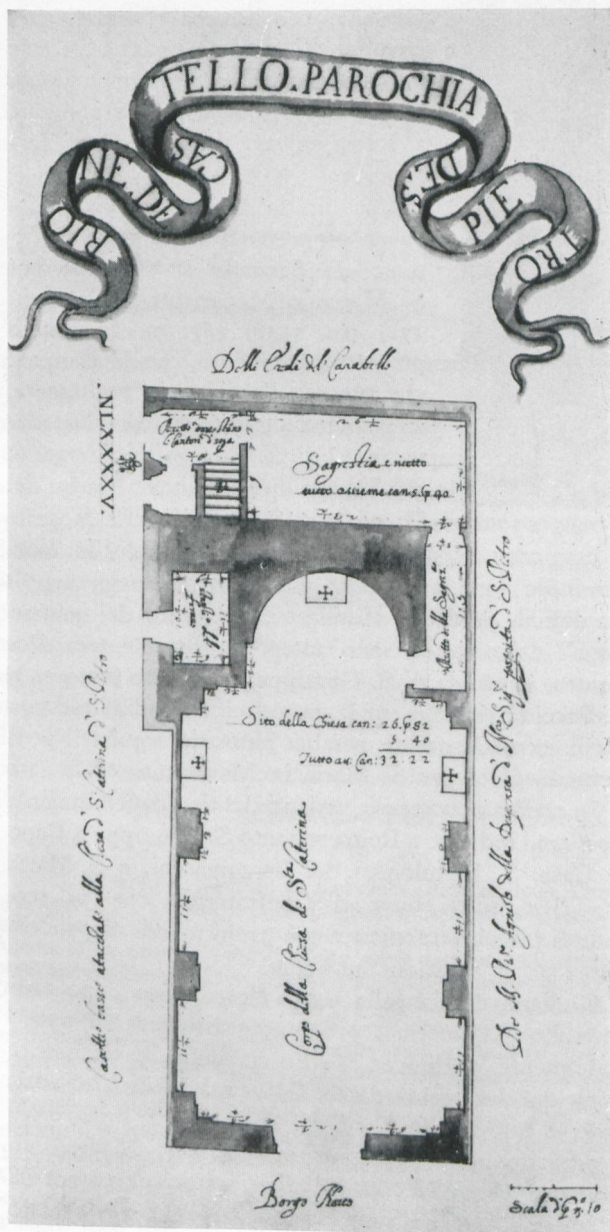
Roma, Bibliot. Vaticana - O. Torriani: Pianta della chiesa di S. Caterina delle Cavallerotte
